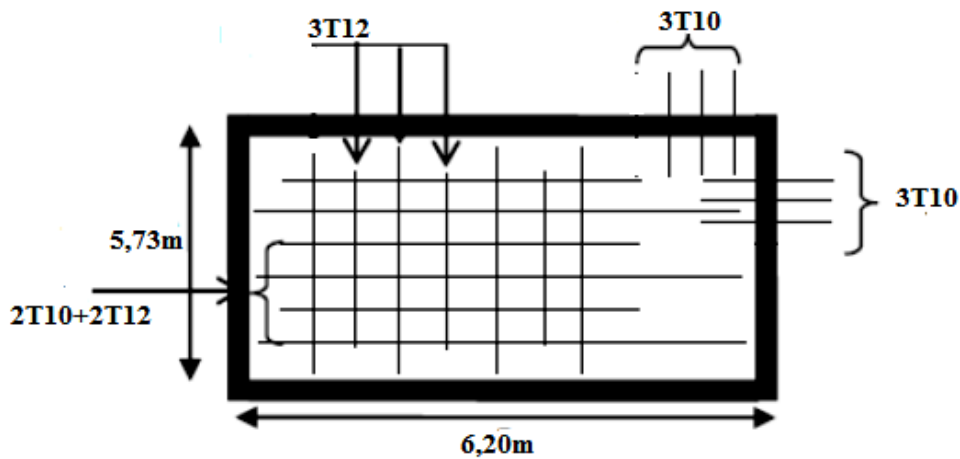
Ferraillage de la dalle pleine du 1^{er} sous-sol
